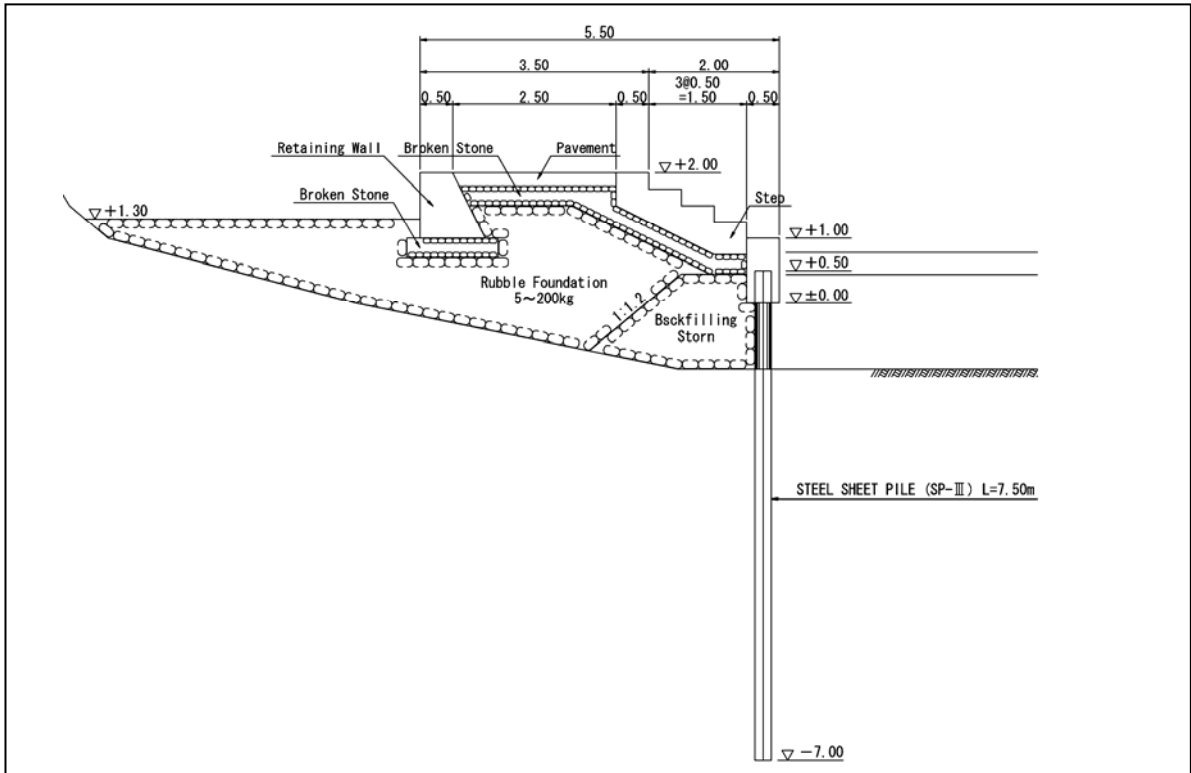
北港護岸(小型船係留施設)標準断面図
